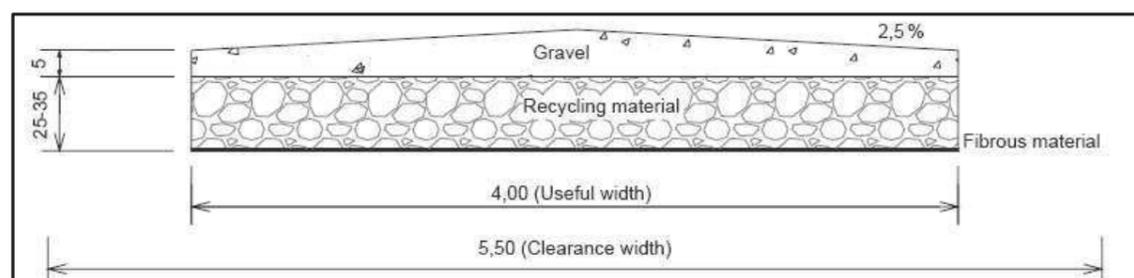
schéma de principe : coupe de la bande de roulement d'une piste d'accès
